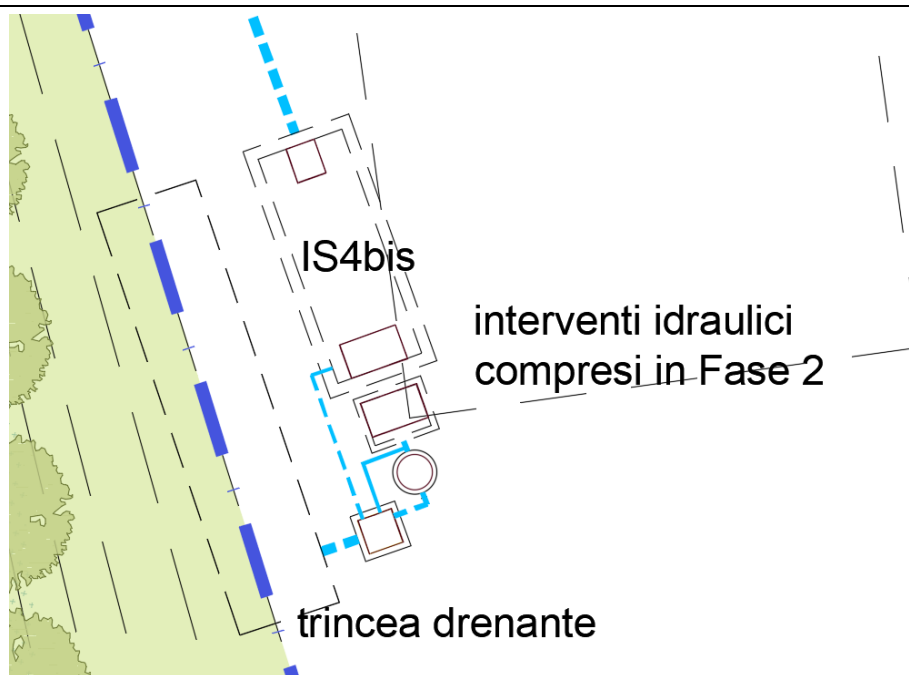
Stralcio planimetrico con dettaglio della vasca IS4bis e trincea drenante (FASE 2)
